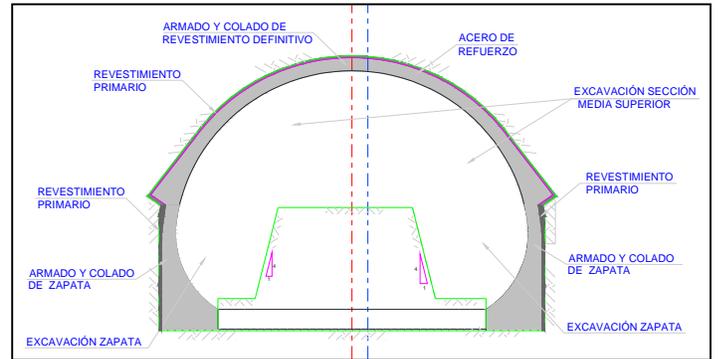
Corte de excavación y revestimiento de Zapata 2
